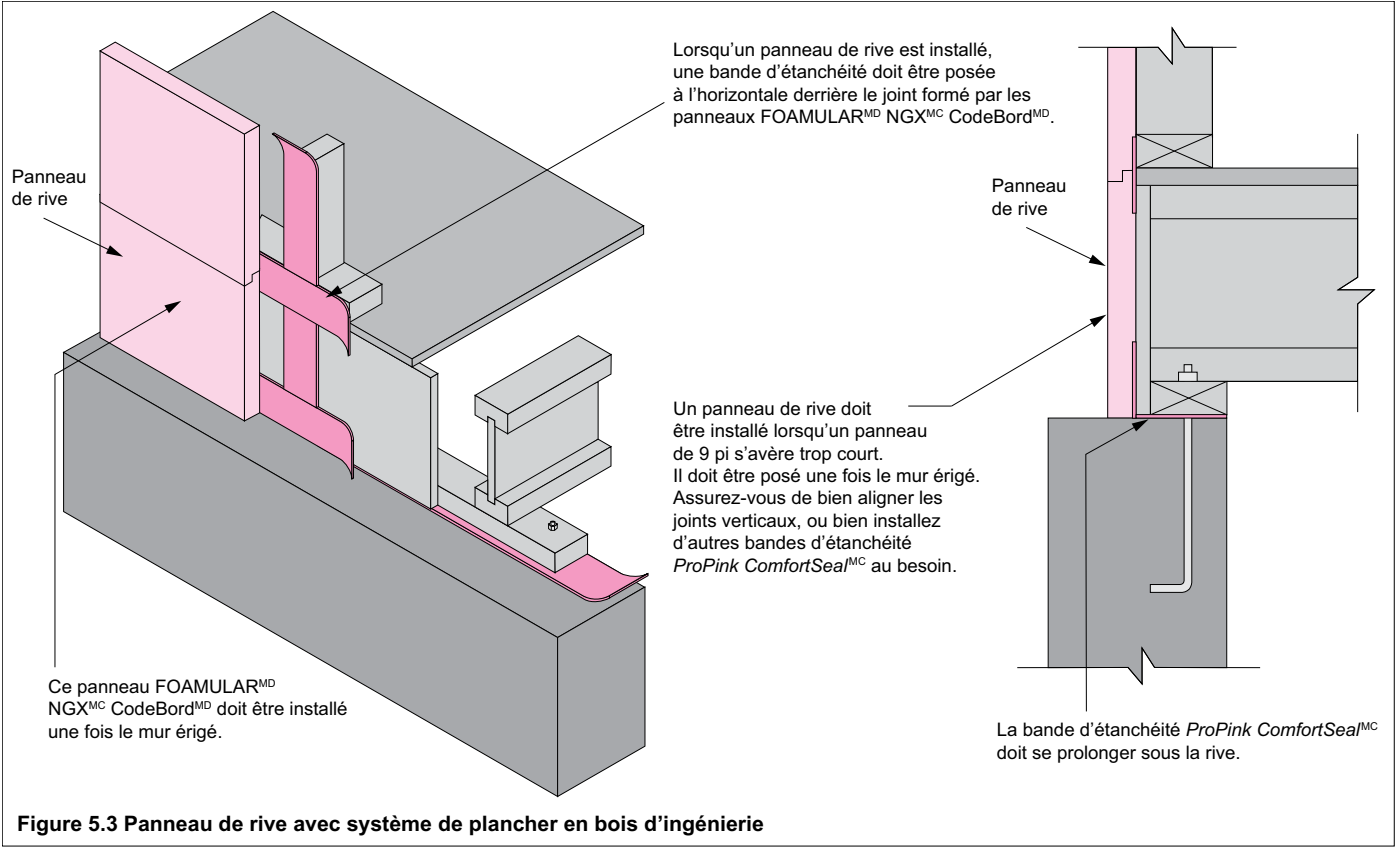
Panneau de rive avec système de plancher en bois d'ingénierie
